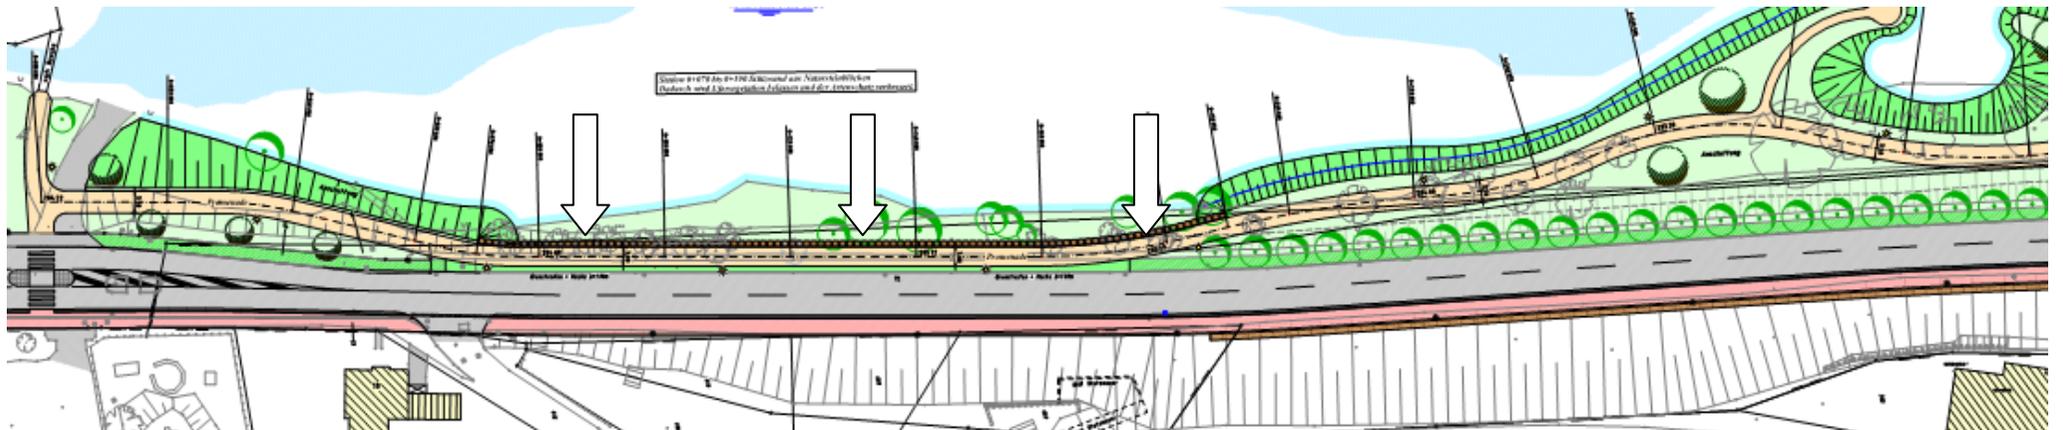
Variante 4 - Genehmigungsplanung: - Auszug - Lageplan Süd – Bearbeitungsstand: 24.05.2013
